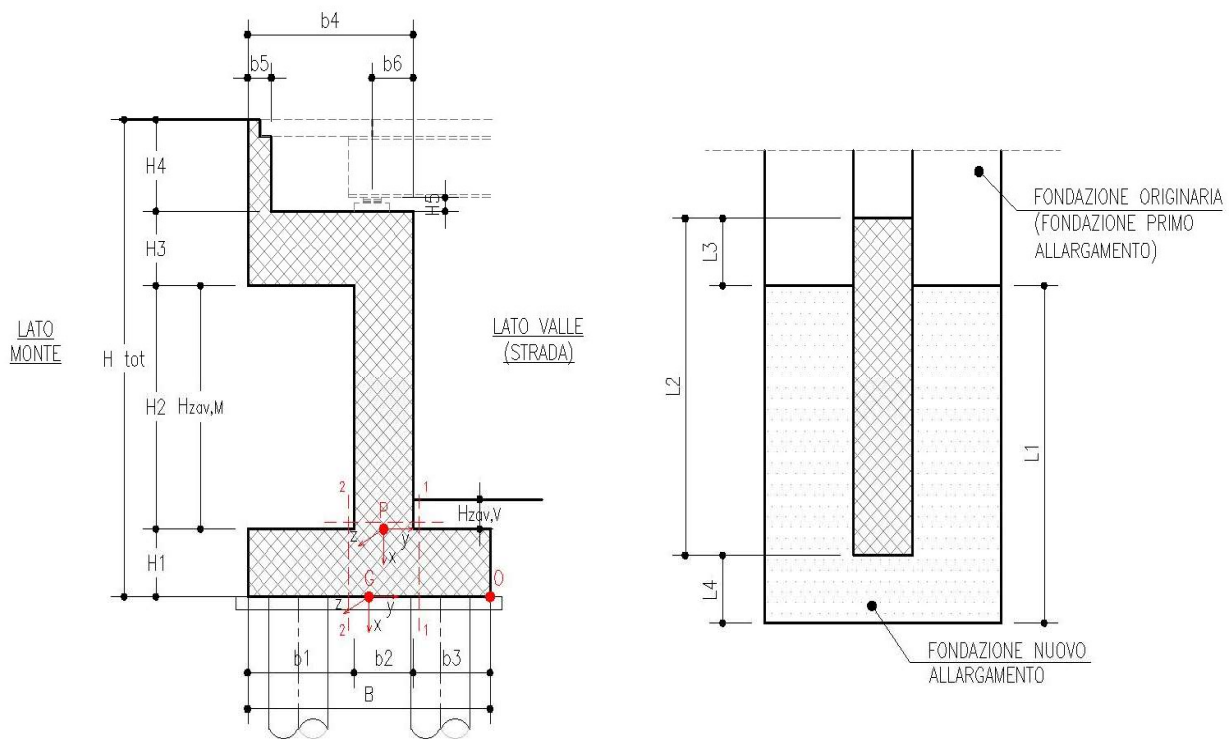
Schema dimensioni geometriche spalla
